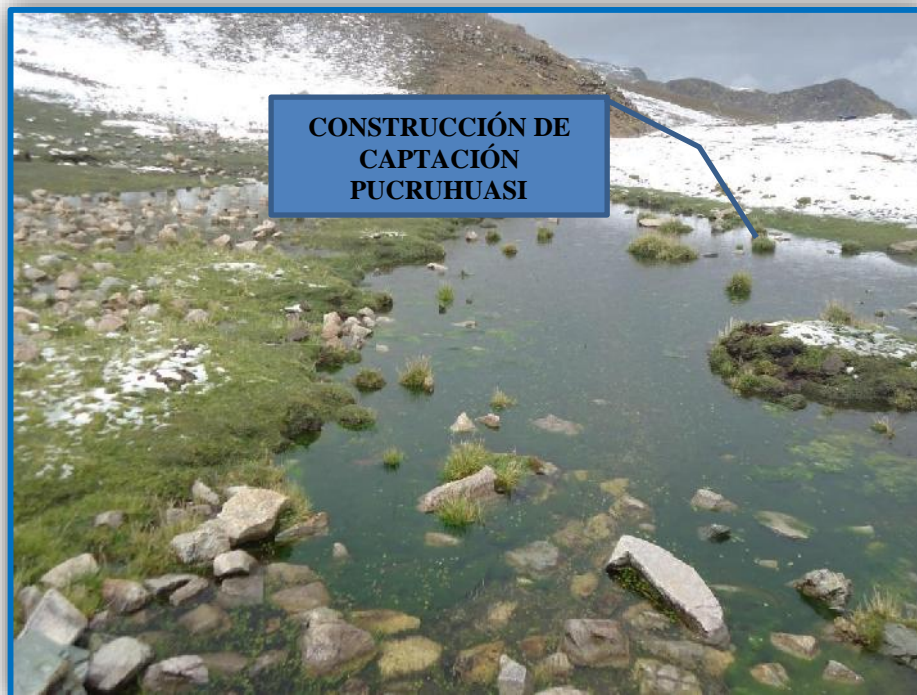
Manantial pucruhuasi, lugar donde se proyecta la construcción de
